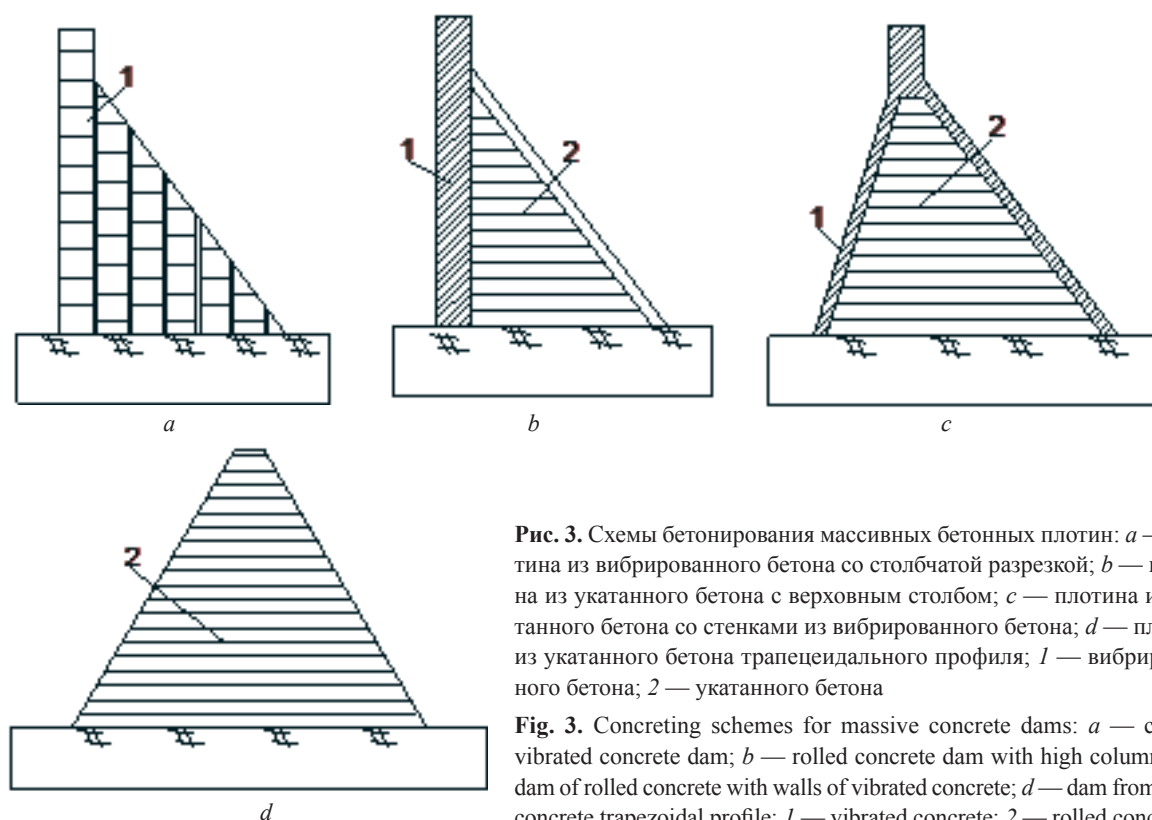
Схемы бетонирования массивных бетонных плотин: *a* — плотина из вибрированного бетона со столбчатой разрезкой; *b* — плотина из укатанного бетона с верховным столбом; *c* — плотина из укатанного бетона со стенками из вибрированного бетона; *d* — плотина из укатанного бетона трапециевидального профиля; 1 — вибрированного бетона; 2 — укатанного бетона
